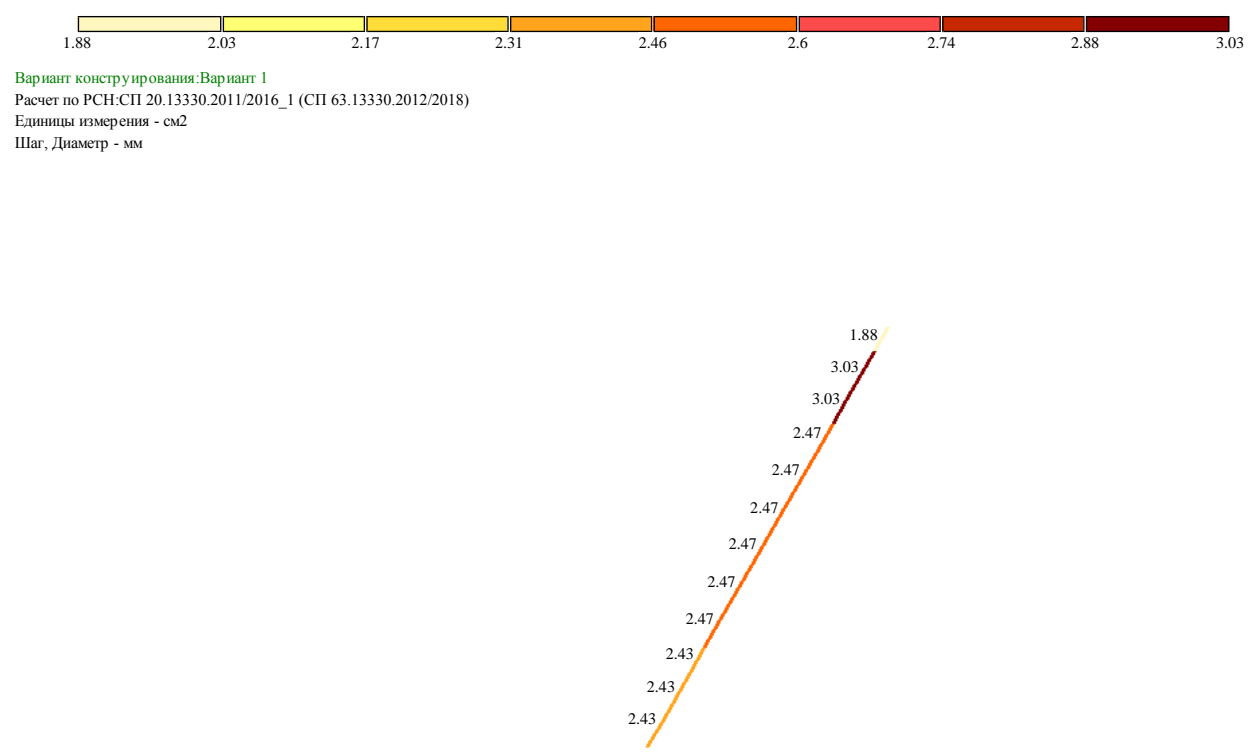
Суммарное значение сечения арматуры вдоль ростверка по нижней грани сечения ростверка (3,03см2), принято 4,4см2.
